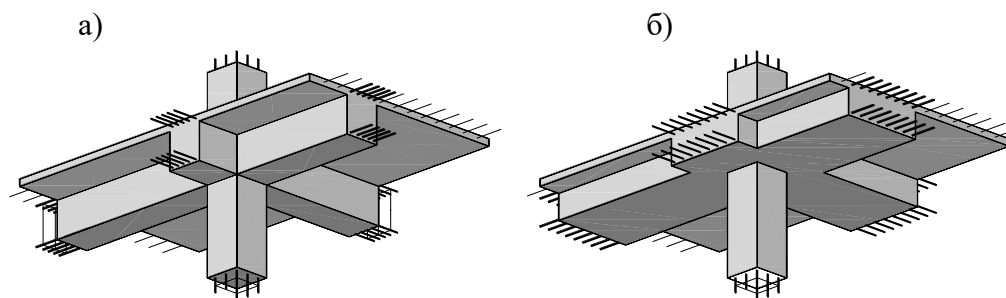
Принципиальные схемы примыкания к колоннам:
